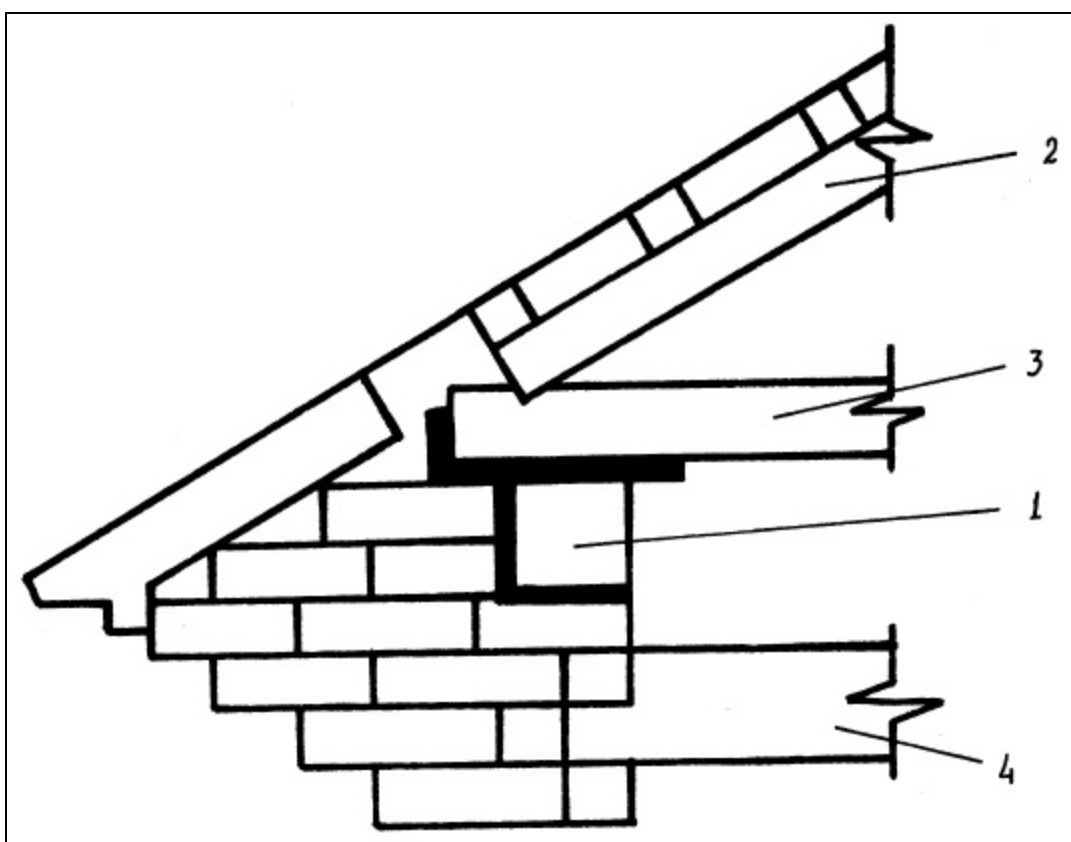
Крепление стропильных ног на верхние венцы. 1 – шип, 2 – стропильная нога.
